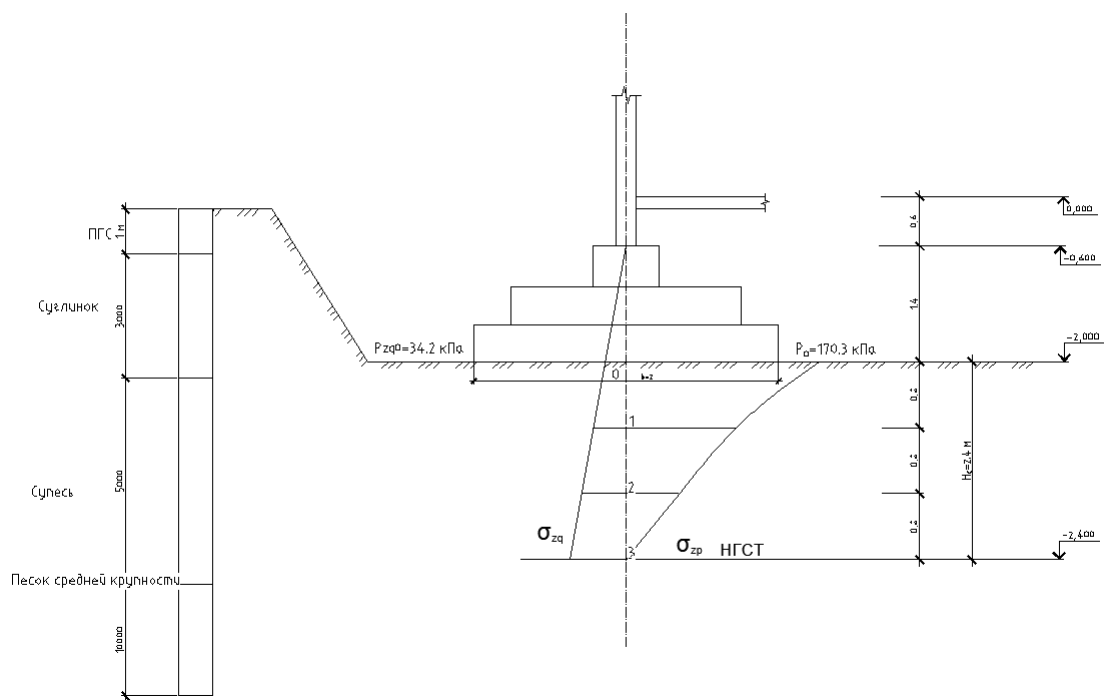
К расчету осадки фундамента мелкого заложения колонны среднего ряда.
